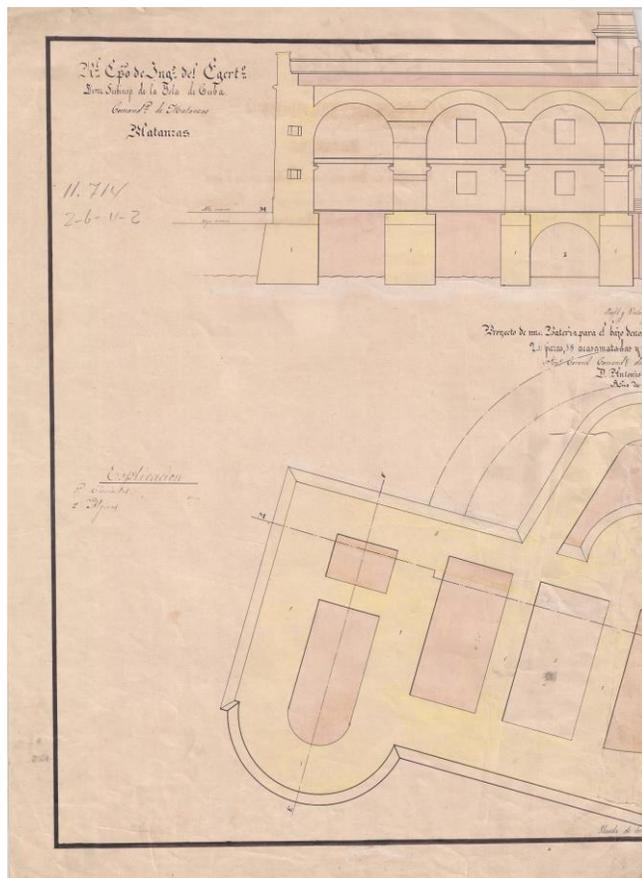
Parte del proyecto de batería para el bajo denominado de la Laja capaz de contener 24 piezas de 18 acasamatadas y 6 en la plataforma superior (1853). AGM, CUB-24-15
